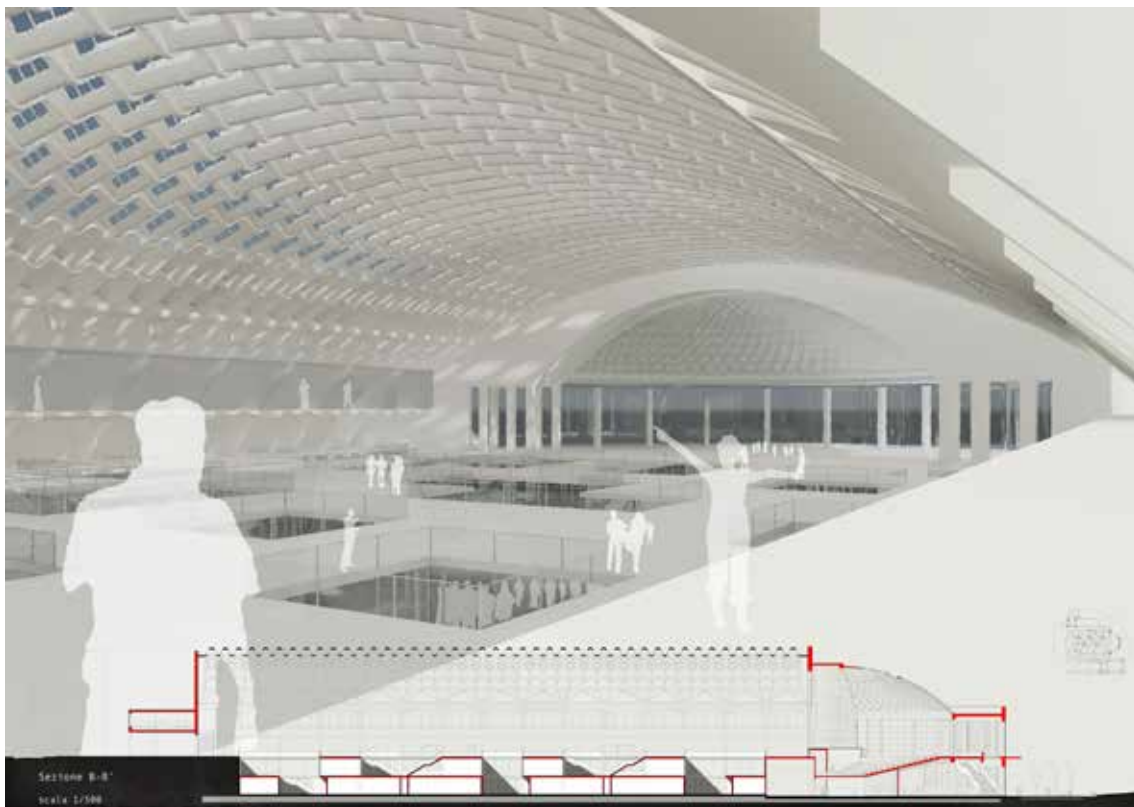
Progetto di Carlo Russo: vista generale e sezione longitudinale.
